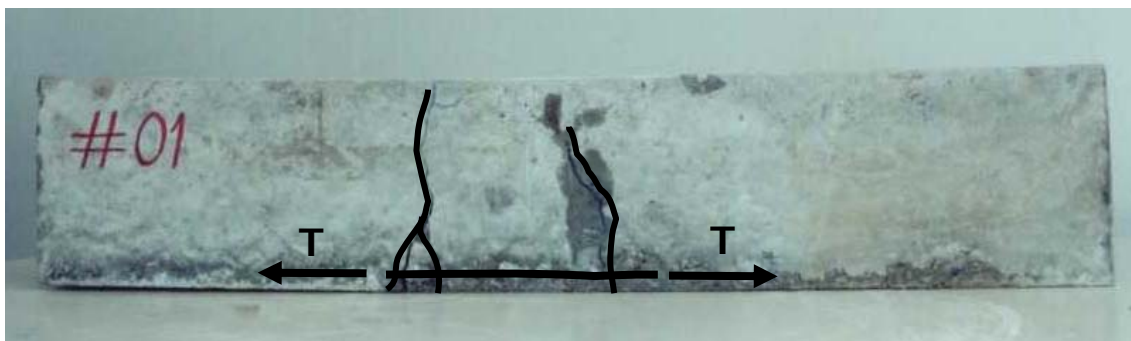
Modelo de ruptura – fissuras verticais entre as cargas
